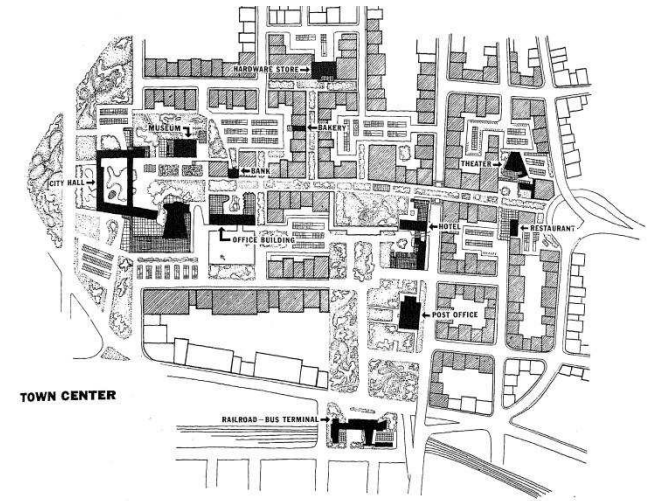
Plano de emplazamiento. Artículo “New Buildings for 194X”. Revista Architectural Forum.
